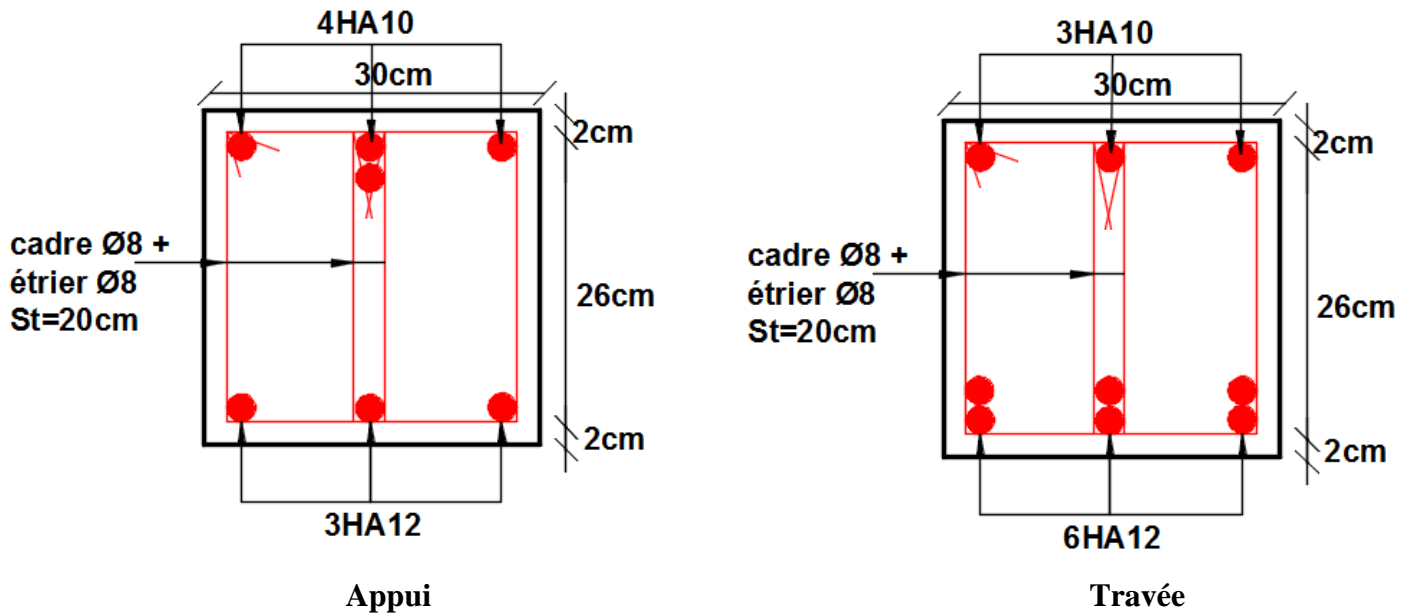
Schéma de ferrailage de la poutre de chaînage
